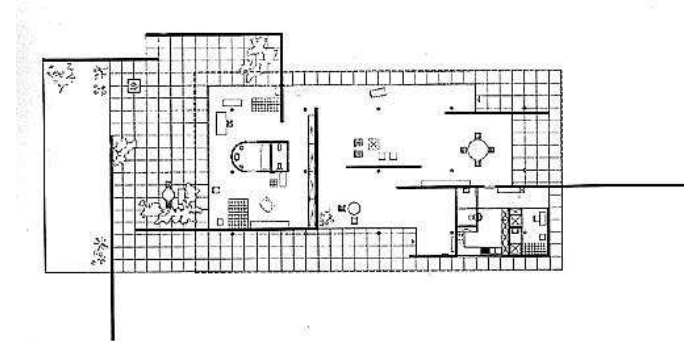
Casa Tugendhat (planta do pavimento superior), 1930
